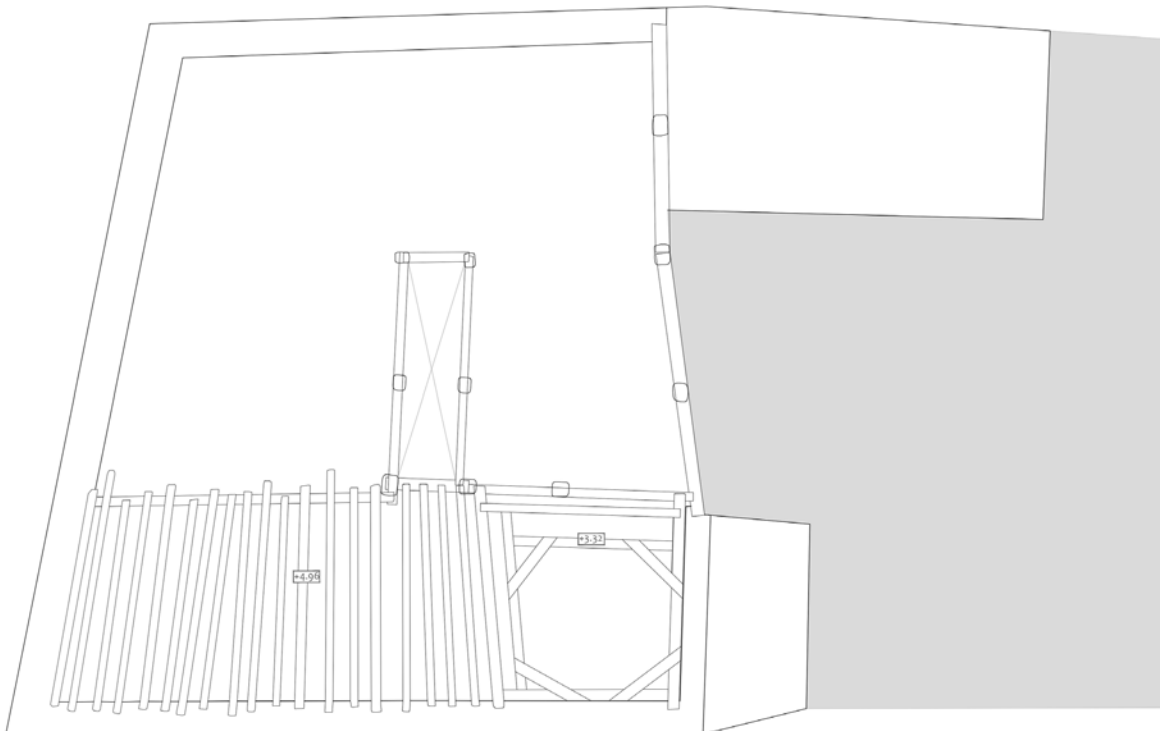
Techo planta primera-habitación principal y alcoba
